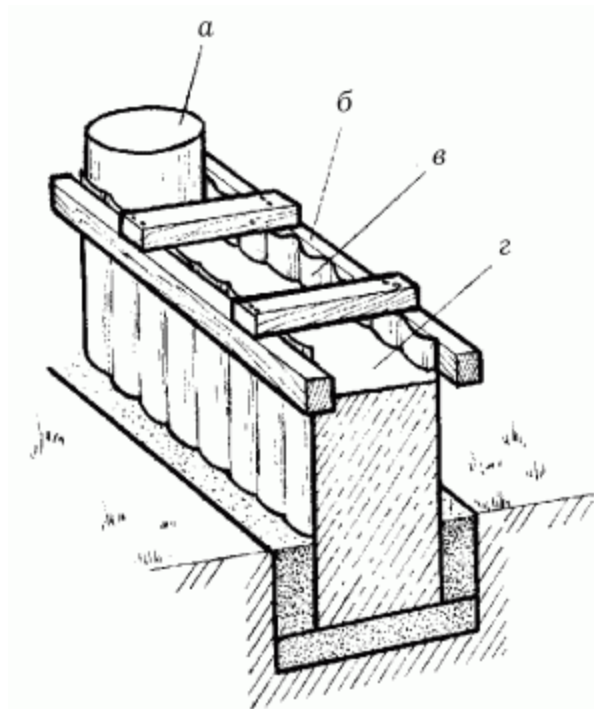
Возведение насыпных стен при устройстве столбчатого фундамента: а – фундаментный столб; б – деревянная рама; в – шифер; г – минеральная засыпка.
